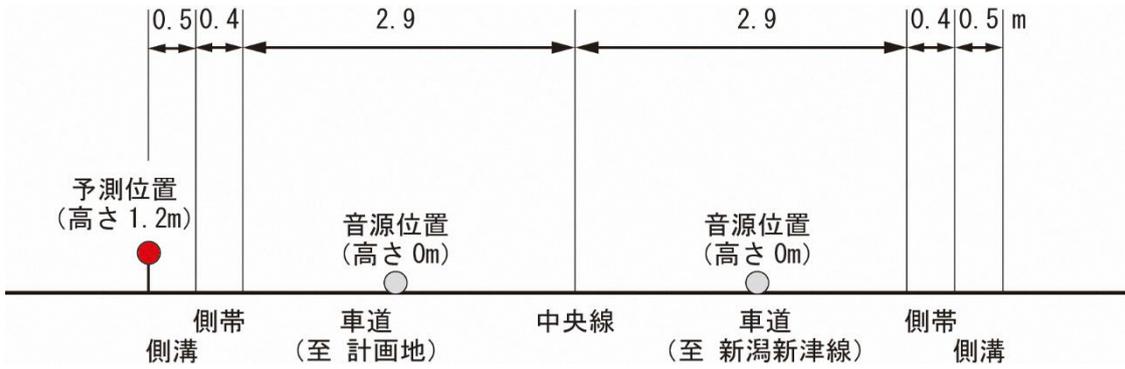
(5) 道路断面図 (No.5 : 新施設東側沿道)
